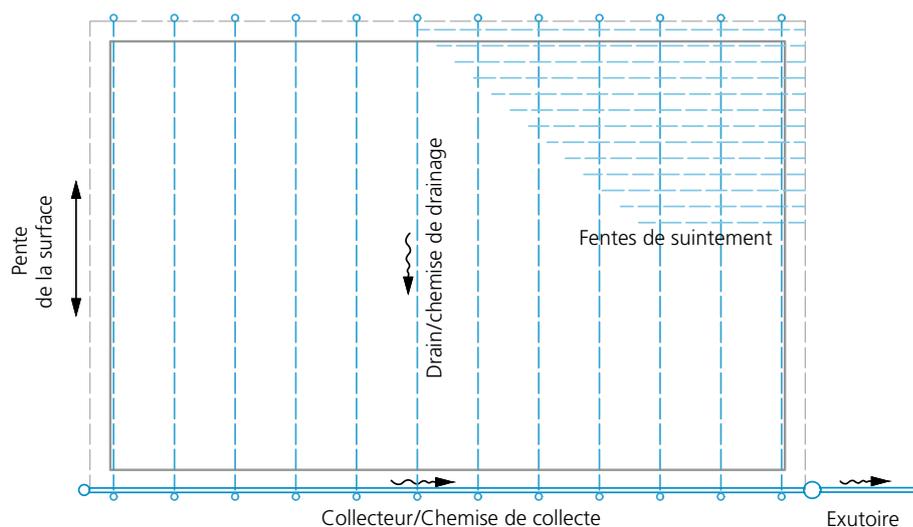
Configuration du drainage pour une construction semblable au sol en place.
